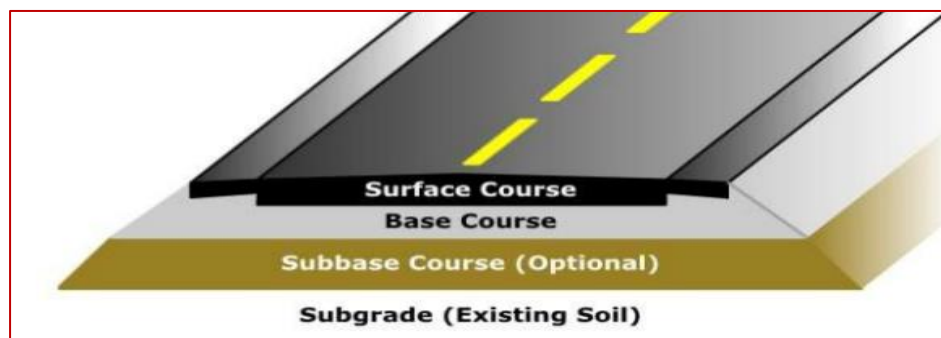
Esquema típico del paquete estructural de un pavimento flexible
